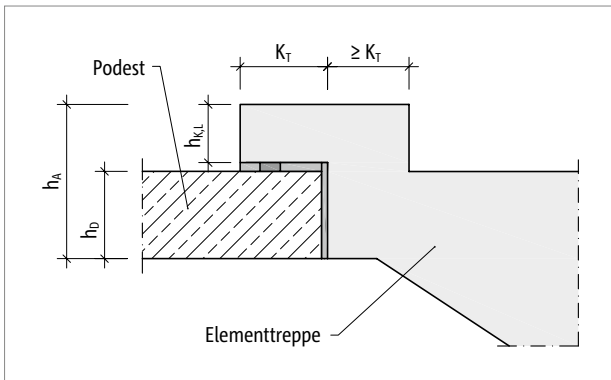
Schöck Tronsole® Typ BL: Bemessung
